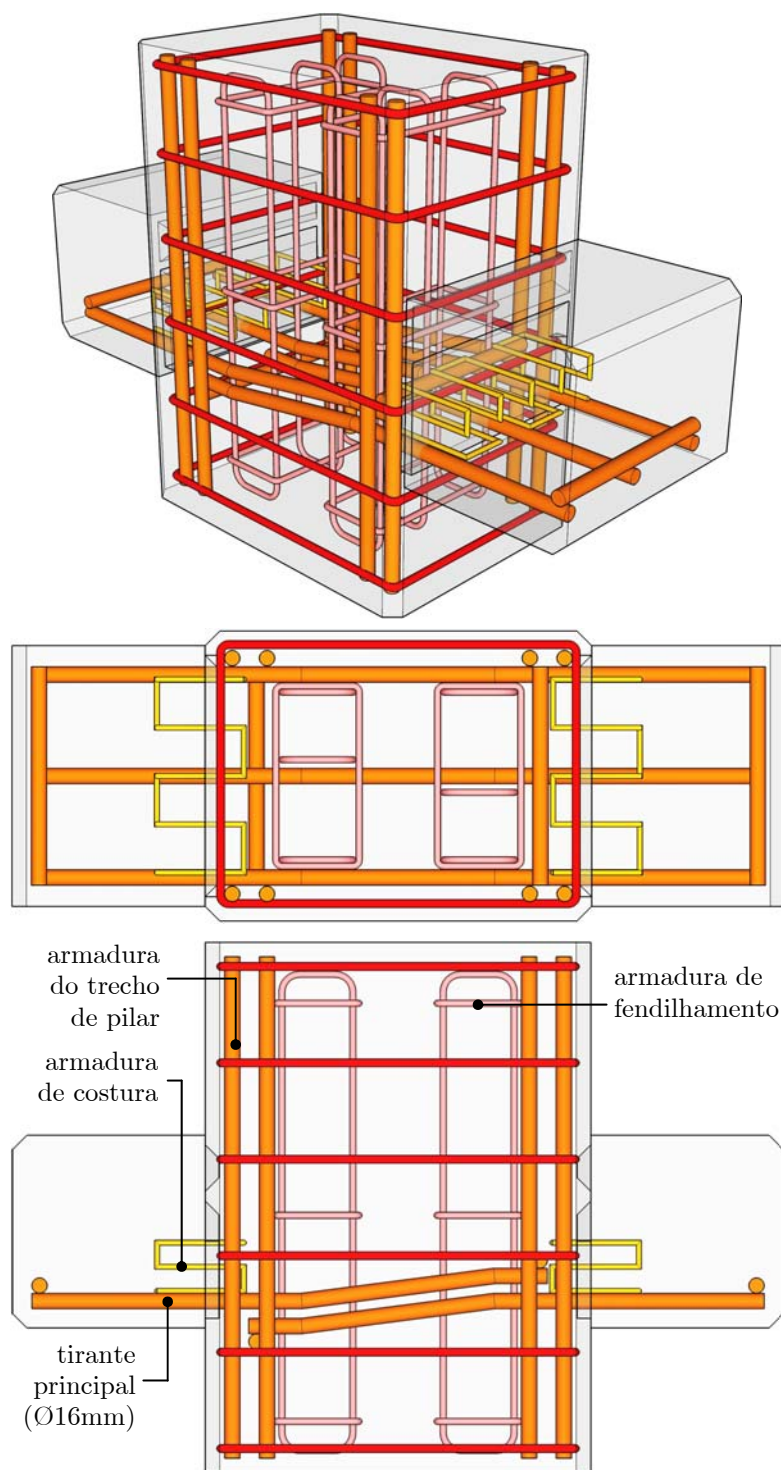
Detalhes das armaduras dos modelos MMC4 e MMC5.
